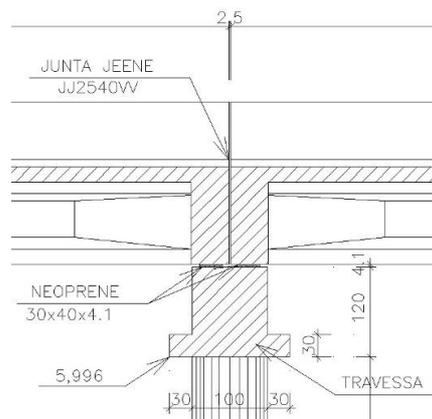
Projeto de ponte nova prevenindo consolas para troca de aparelhos de apoio.
